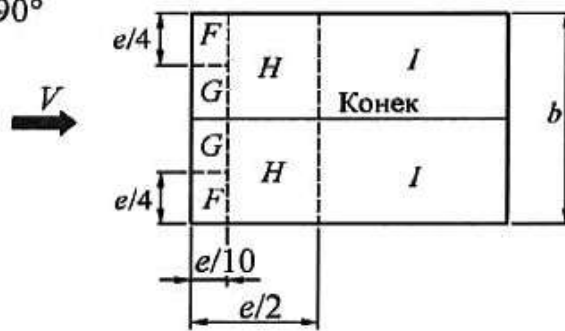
Схема задания ветровой нагрузки на покрытие
